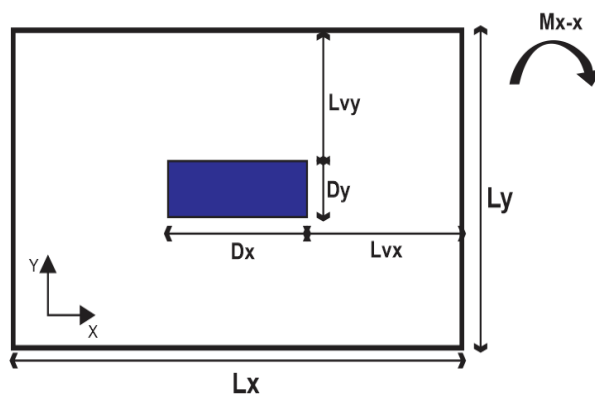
Parámetros de diseño para zapatas aisladas
